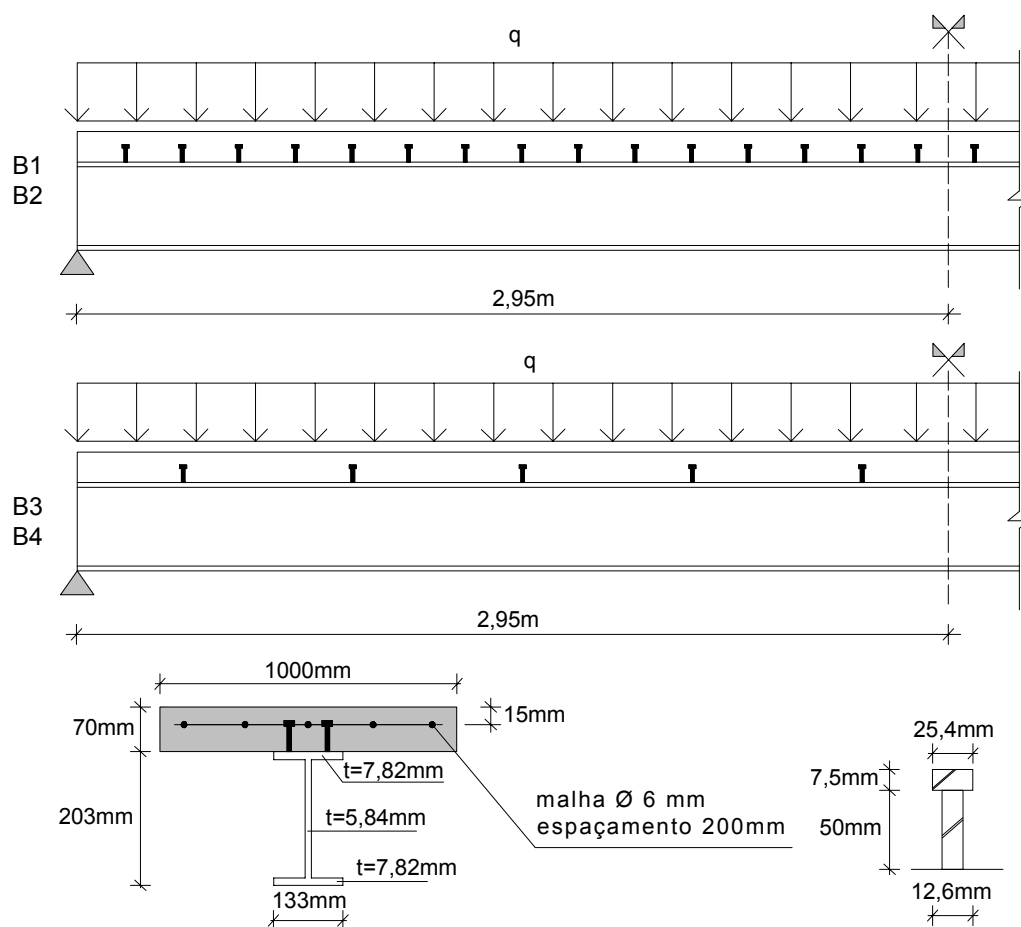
Geometria e seção das vigas mistas de vão simples B1, B2, B3 e B4
